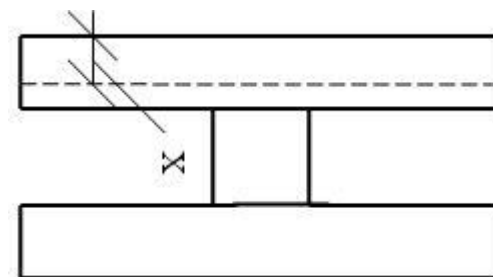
Расчётная схема сжатой зоны высотой  $x$  в сечении сборной плиты перекрытия.
